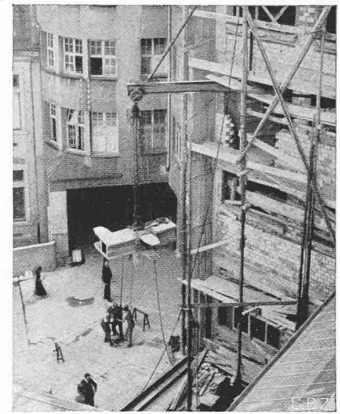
Hochziehen des Kniestückes eines Torsionsträgers
